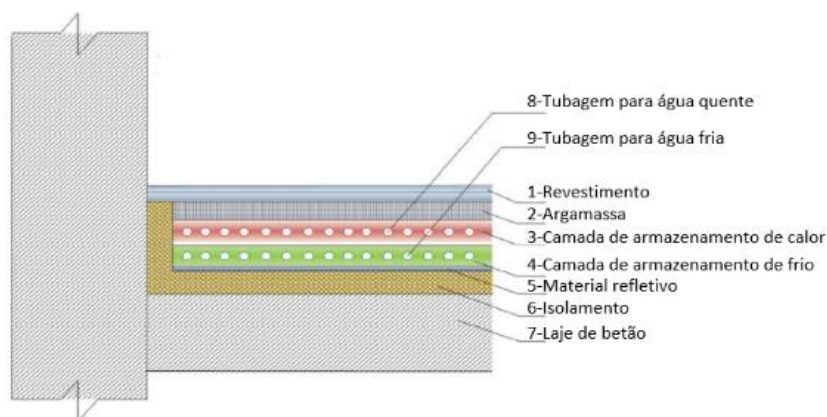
Esquema pavimento radiante de camada dupla aprimorado. Adaptado: [31]
